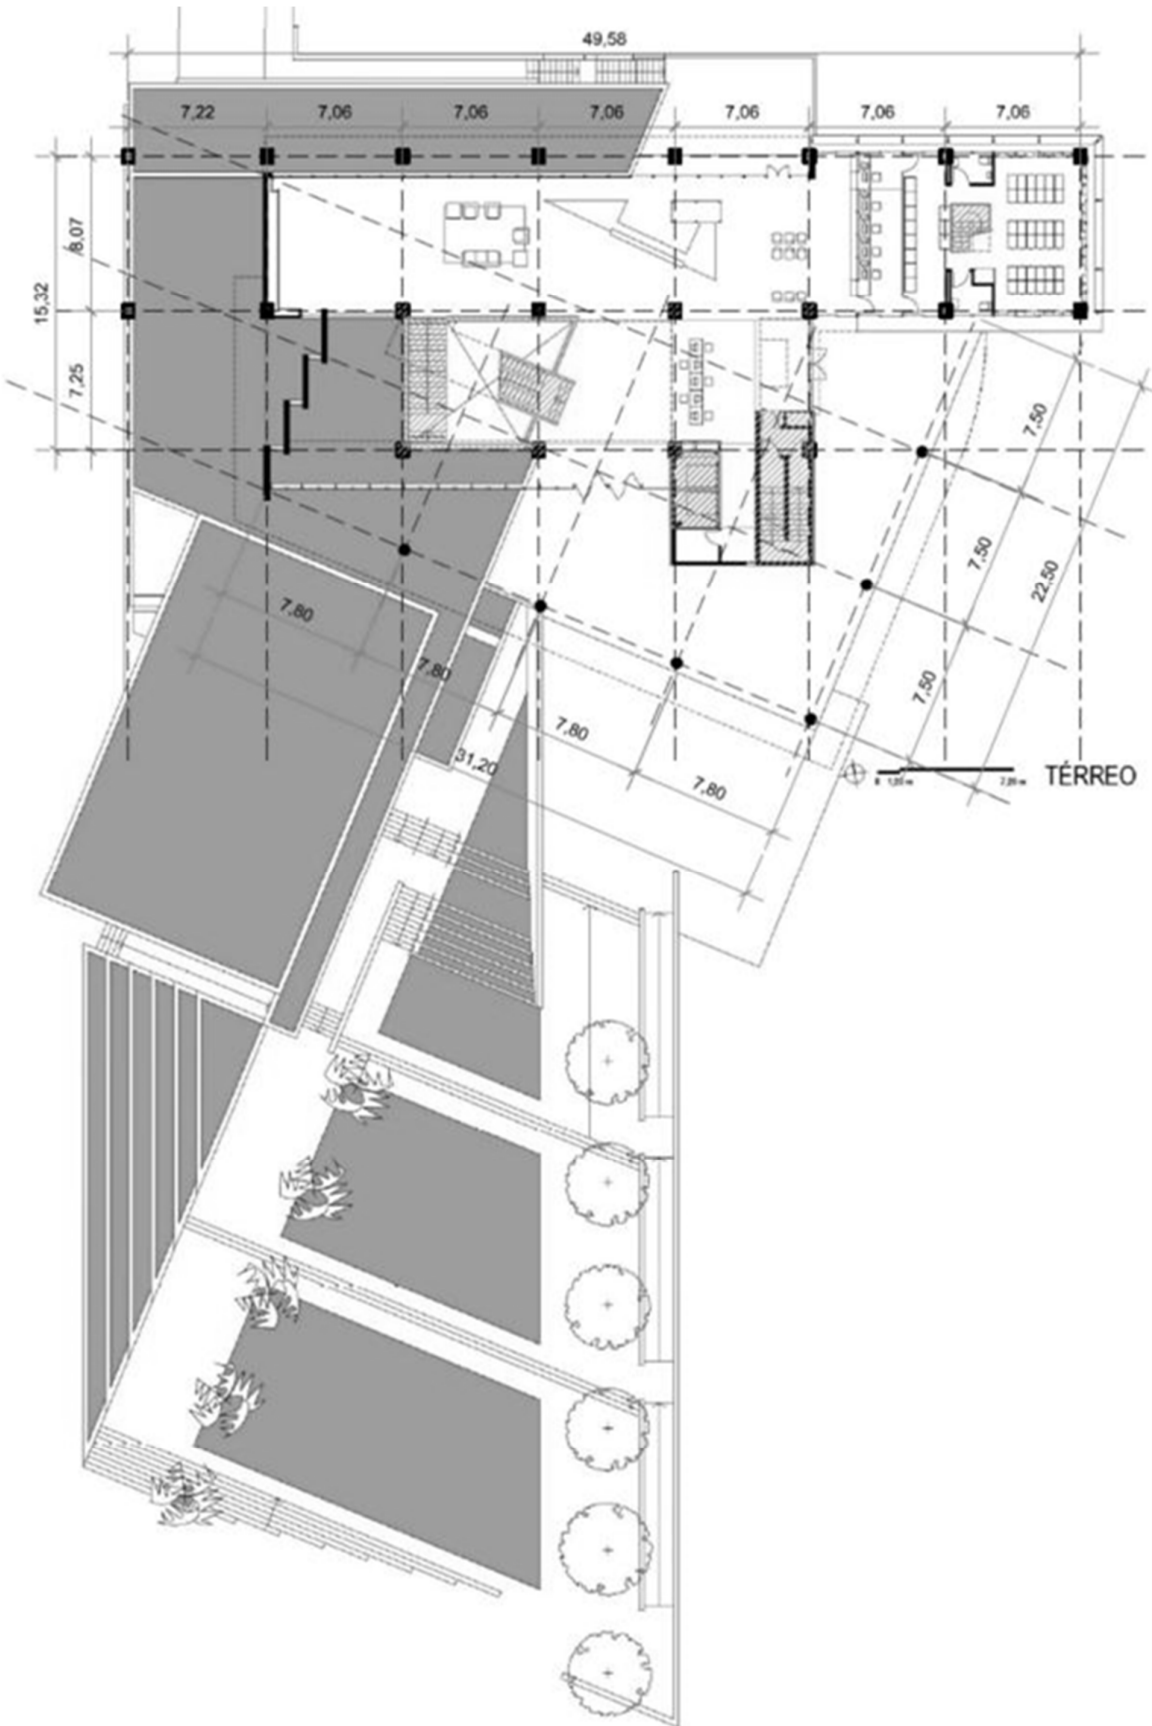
Modulação de projeto demarcada em redesenho da planta baixa térreo de Prédio 02 - FAPA (2007).
